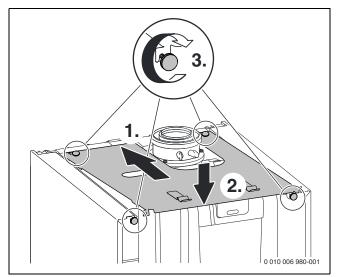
Glisser le carénage supérieur vers l'arrière et fixer à l'avant et l'arrière avec les 4 vis
